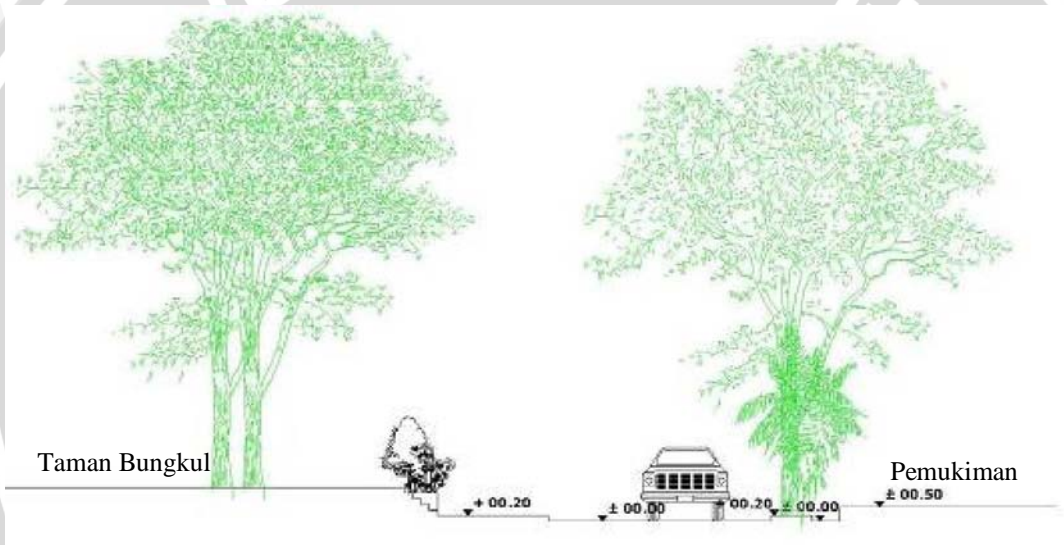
Detail B<sub>4</sub> (Jalan Progo)
